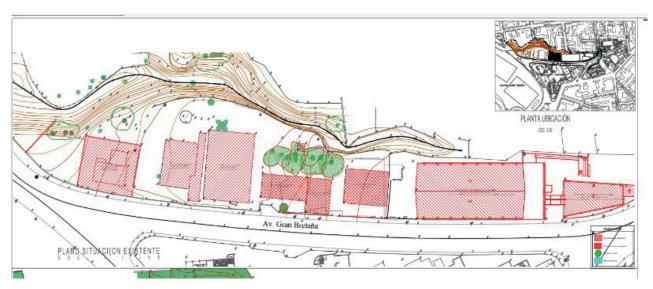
Planta del proyecto. Fuente: Elaboración propia
